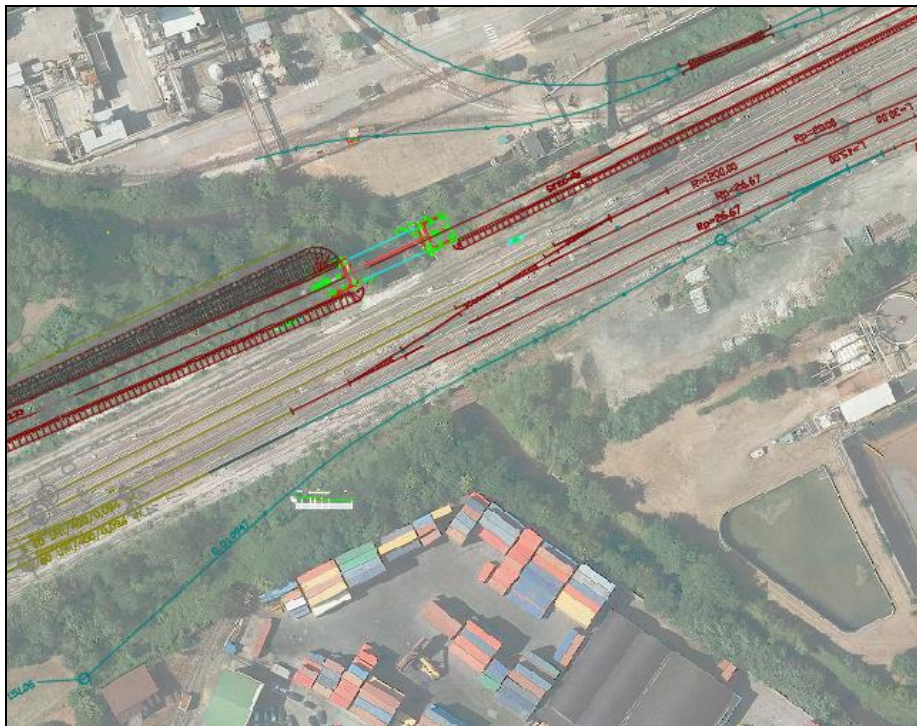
Planimetria nuovo attraversamento ferroviario sul Fiume Olona
